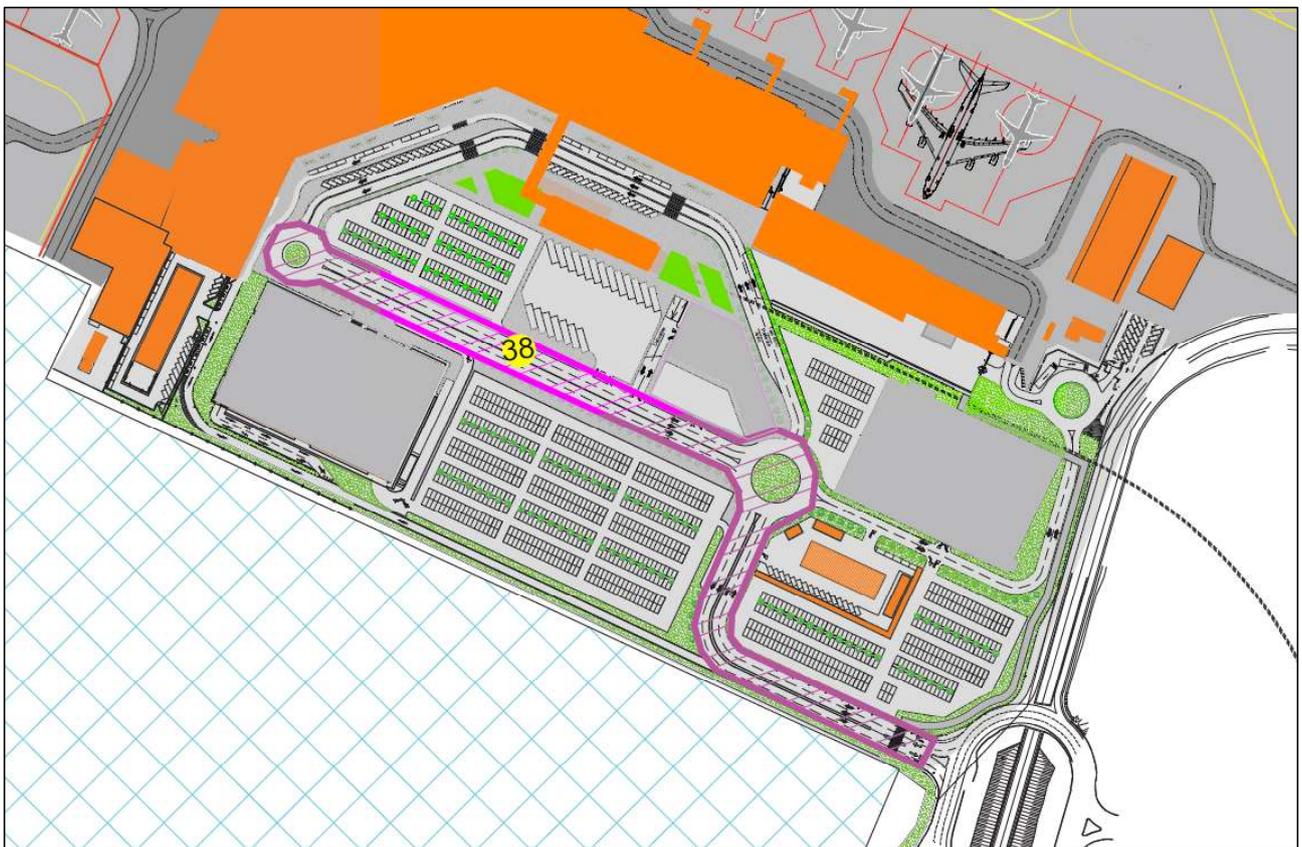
Estratto Master Plan – Nuova Viabilità Landside
